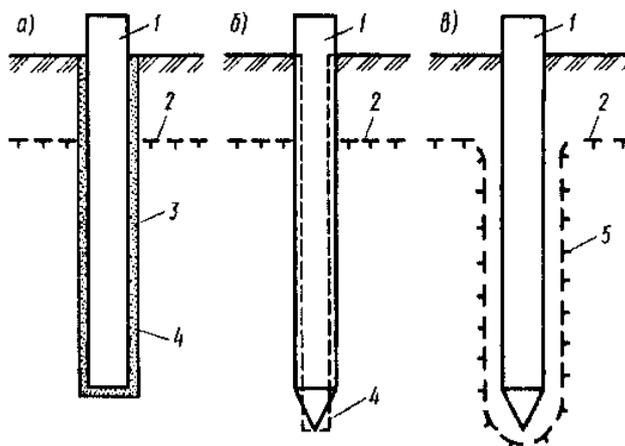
Способы погружения свай в вечномёрзлый грунт: 1 – свая; 2 – верхняя граница вечномёрзлого грунта; 3 – грунтовый раствор; 4 – стенка скважины; 5 – граница оттаивания
